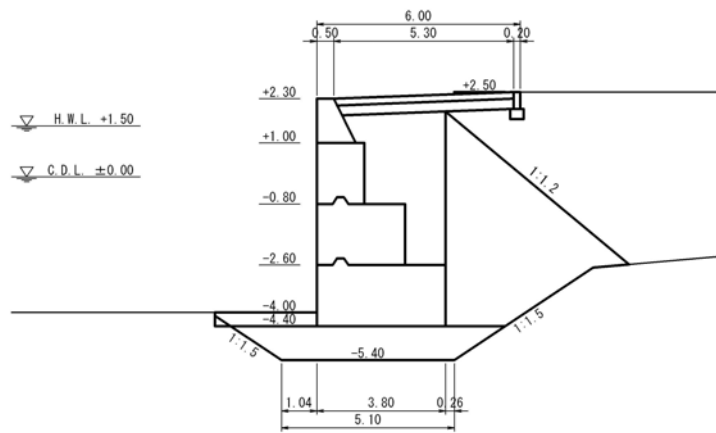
4.0m 岸壁（ブロック積式）断面図
